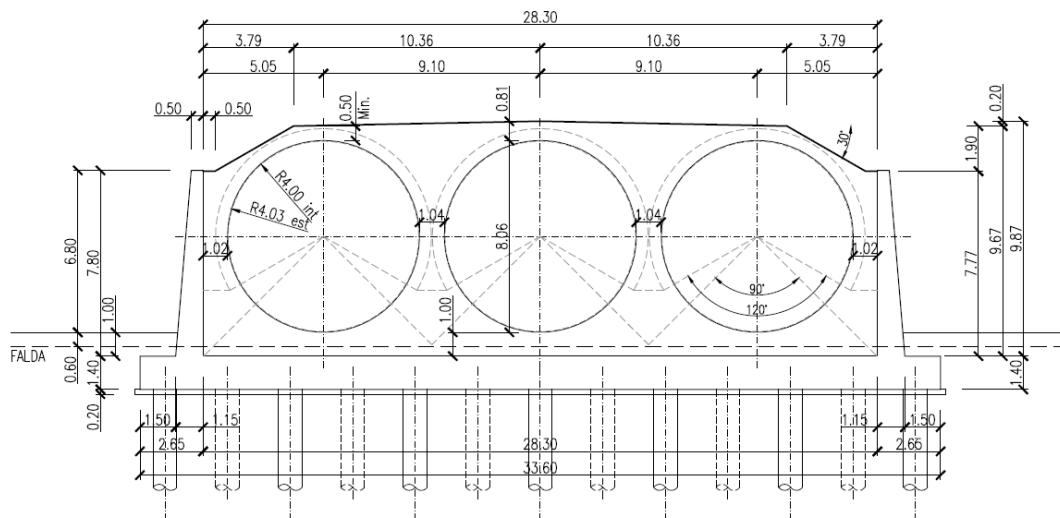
Sezione trasversale opera su fondazioni profonde.
